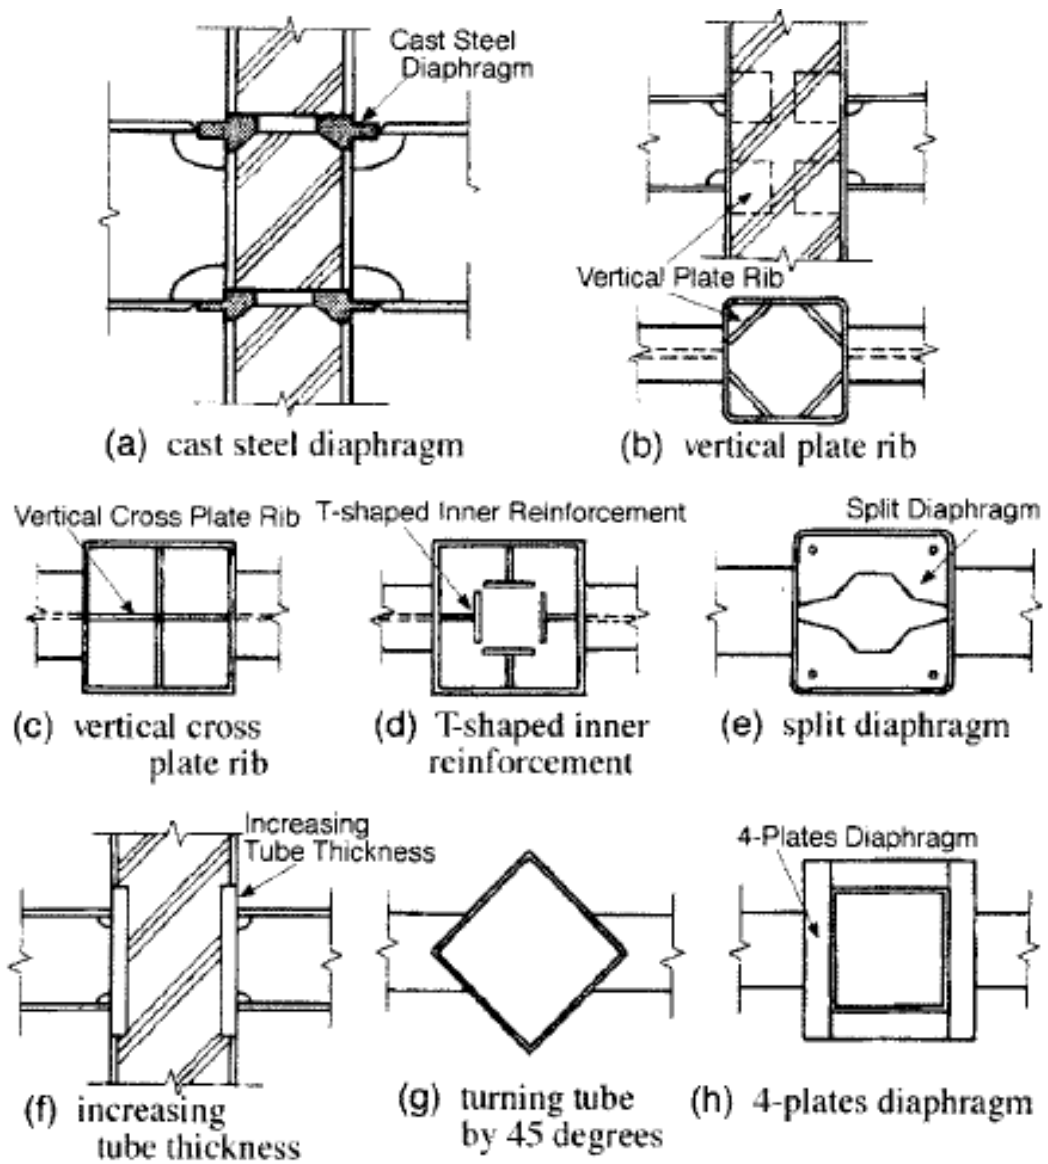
Detalles recientemente desarrollados de conexión de acero viga-columna cuadrada. [18]
